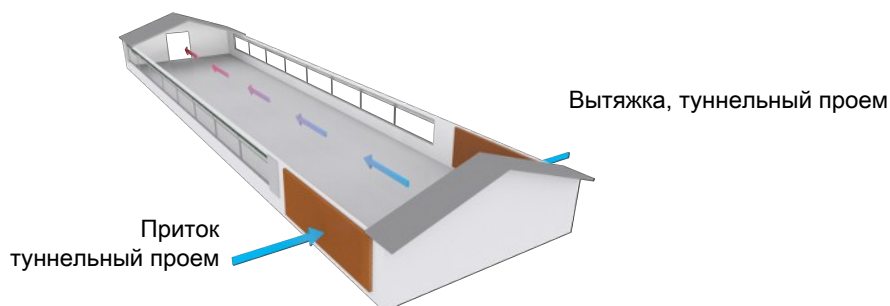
Пример естественно вентилируемого животноводческого дома в сочетании с туннельной вентиляцией, туннельной вентиляцией.
